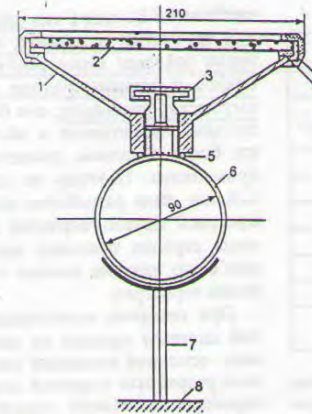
Пластмассовый мелкопузырчатый аэратор НИИ КВОВ с двухслойной пористой пластиной
